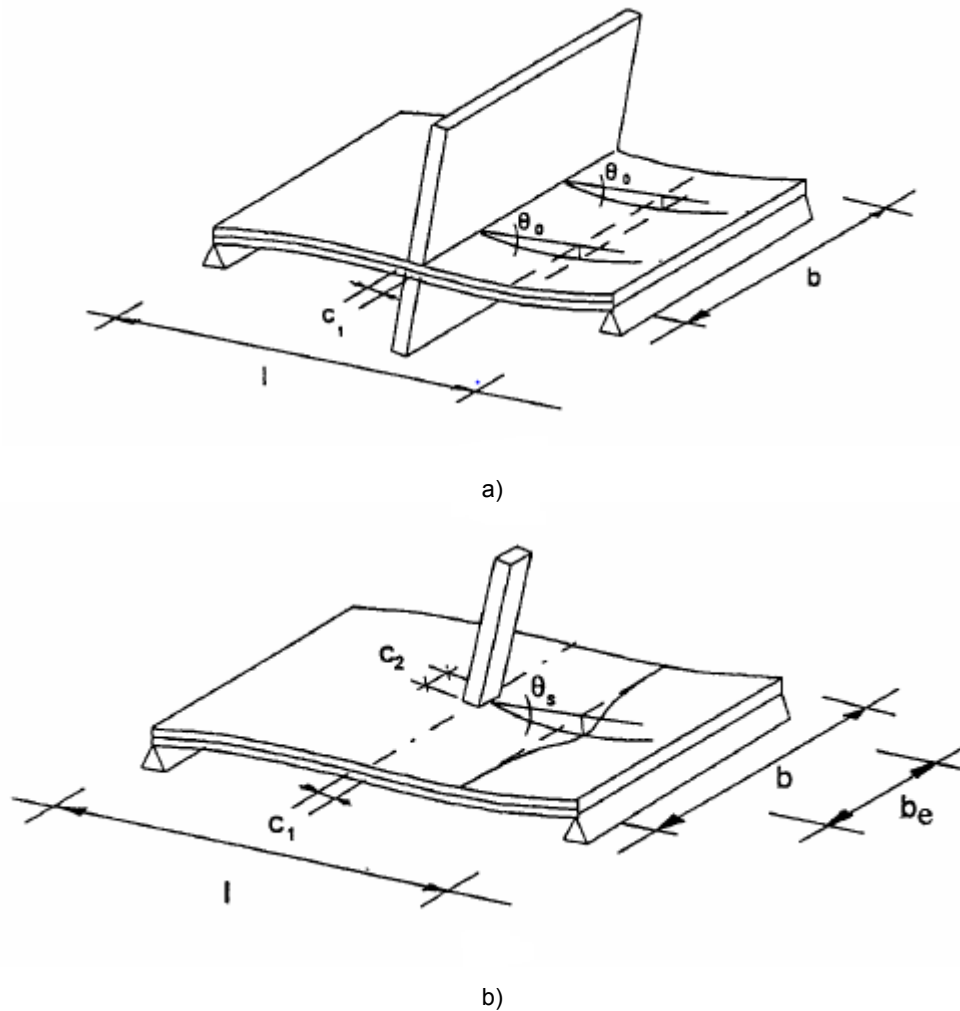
Ligação laje-pilar: a) apoio contínuo (parede); b) apoio pontual (pilar) [1]
